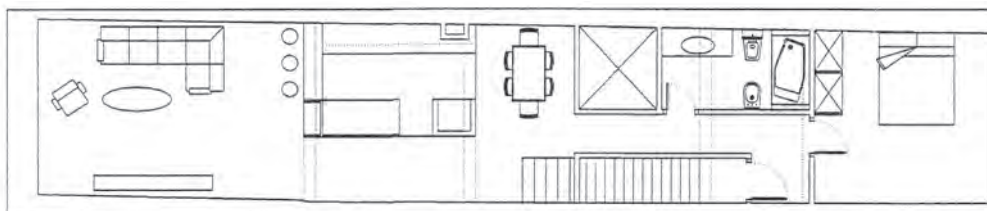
15. 1995 PLANTA SEGUNDA REFORMADA (DUPLEX)
